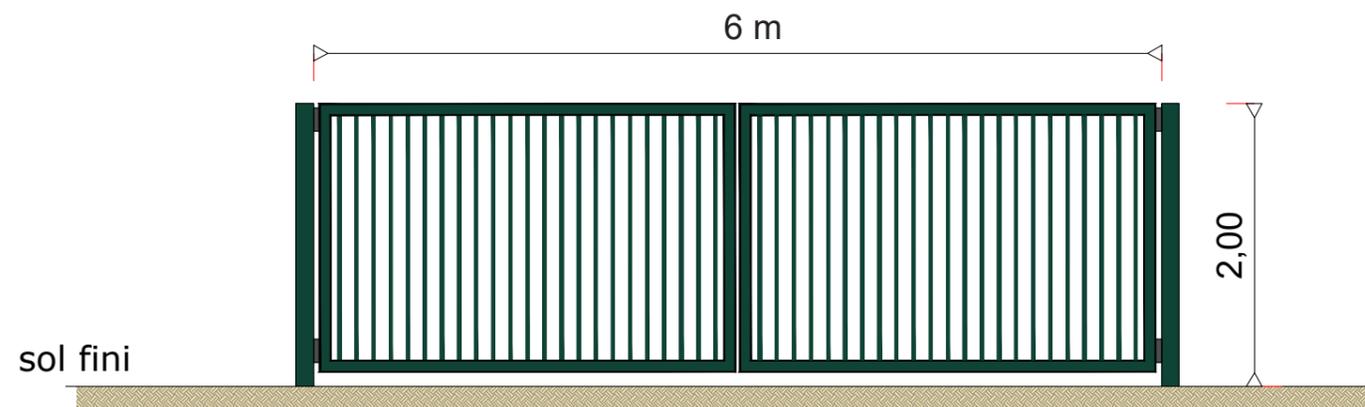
DETAILS - ÉLÉVATIONS DU PORTAIL D'ENTRÉE ET DE LA CLÔTURE - échelle 1/40e
